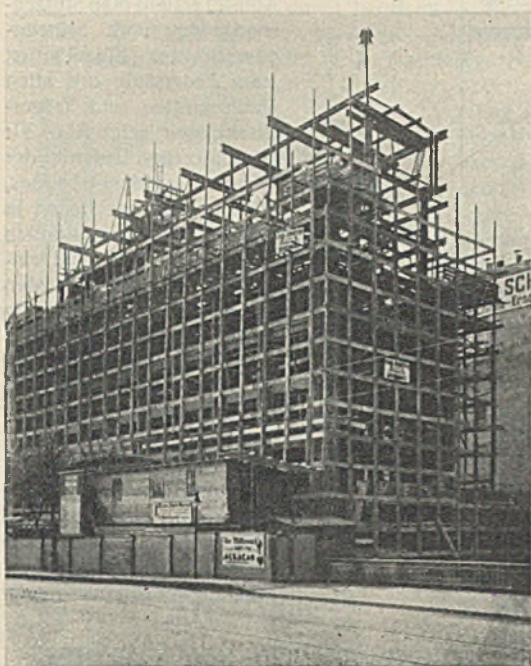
Neubau der Firma Erich Schüler am Heidkampsweg. (Ausführung der Stahlkonstruktion: Carl Spaeter G. m. b. H., Hamburg.)
